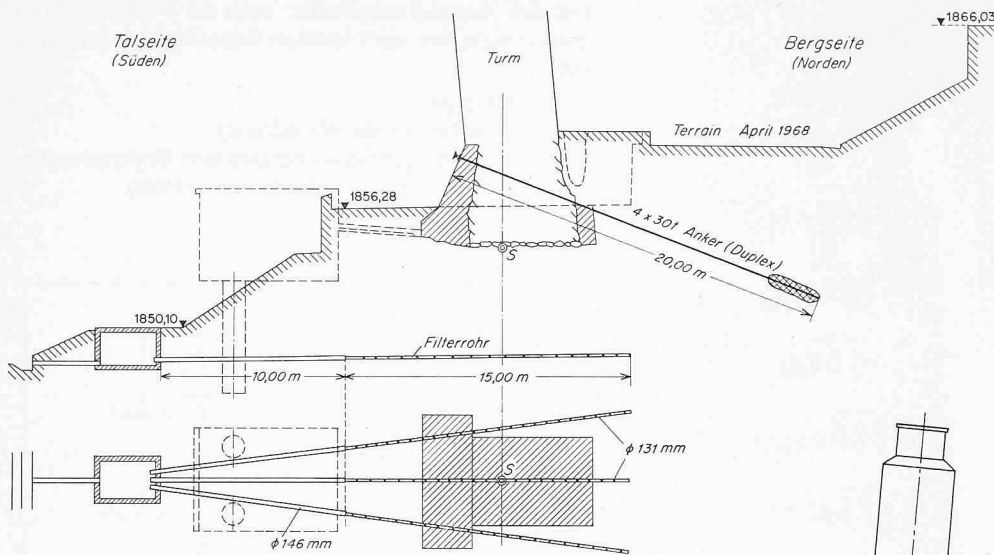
Entwässerungsanlage unter dem Turmfundament mit Alluvialanker (oben Schnitt, unten Grundriss)
